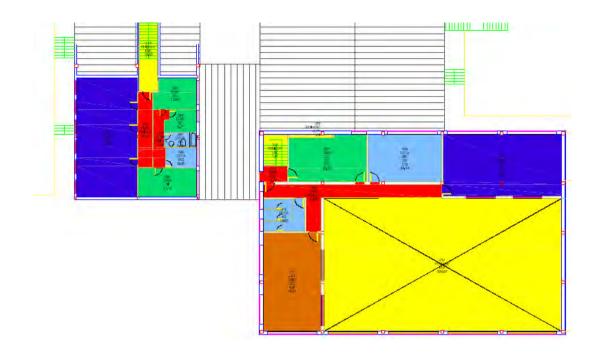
Vista en planta de los espacios en la sede campus de la EEI (Edificio II – Zona IV)
